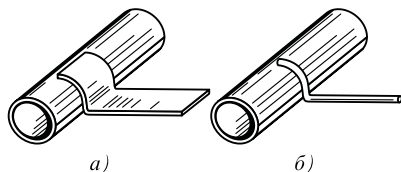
Присоединение к трубопроводу сваркой заземляющего проводника с прямоугольным (а) и круглым (б) сечением
